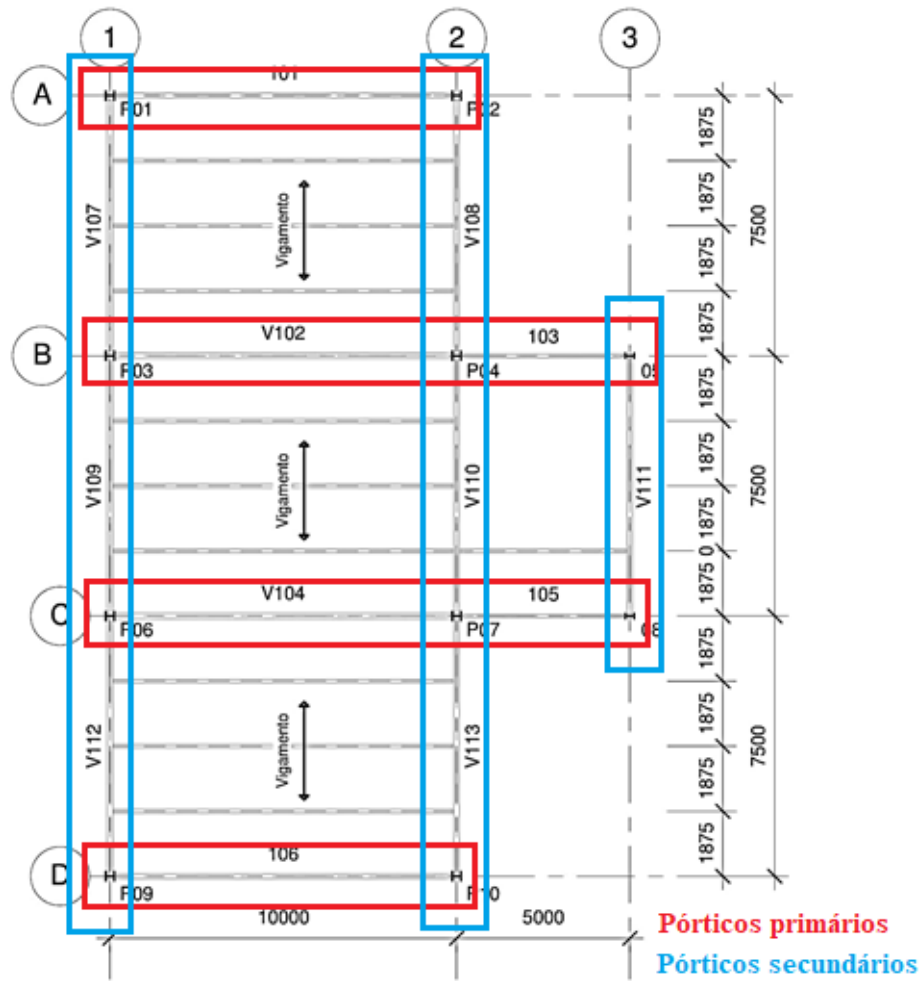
Exemplo de lançamento estrutural (SARAIVA, 2018)
